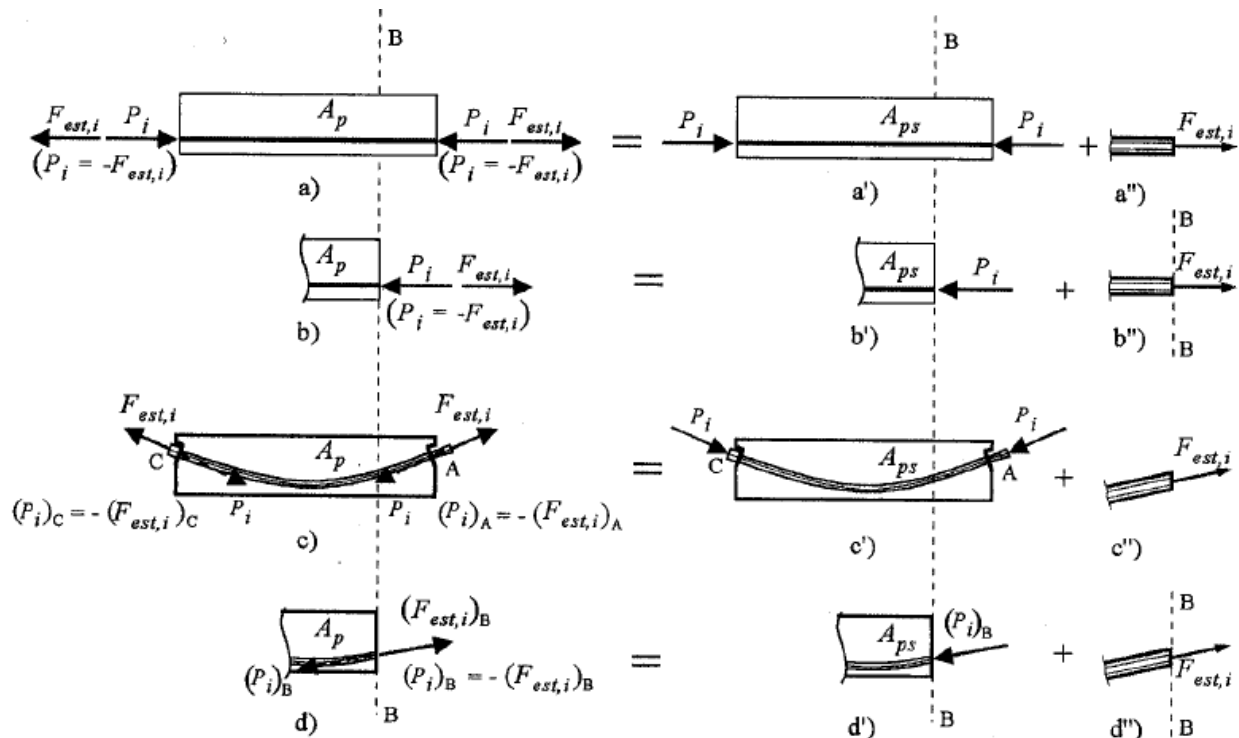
Esquema del pretensado en elementos estructurales con armadura pretesa: (a) Fase pre; (b) Manera alterna para expresar la fase pre.
